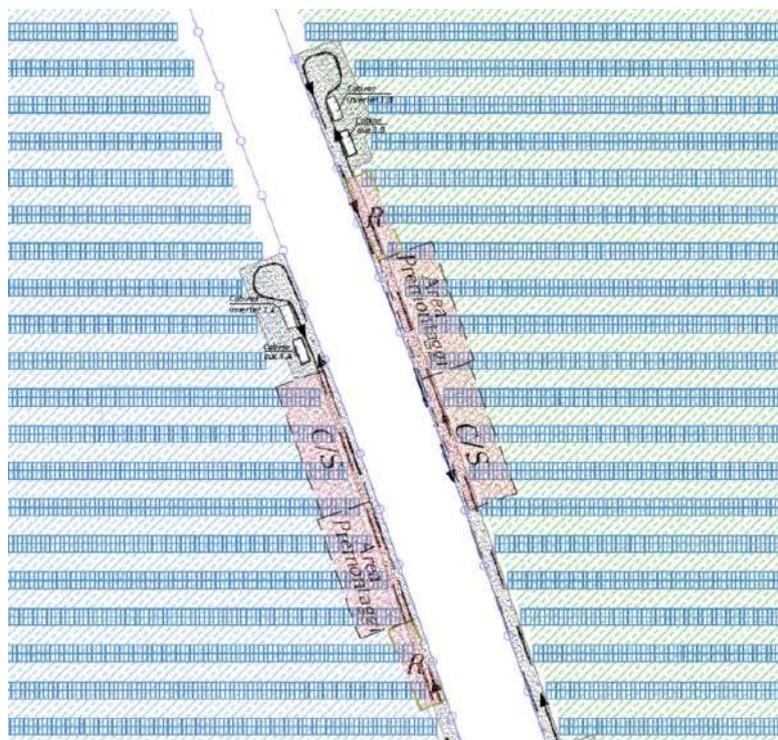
dettaglio area di cantiere “Chions 2”
